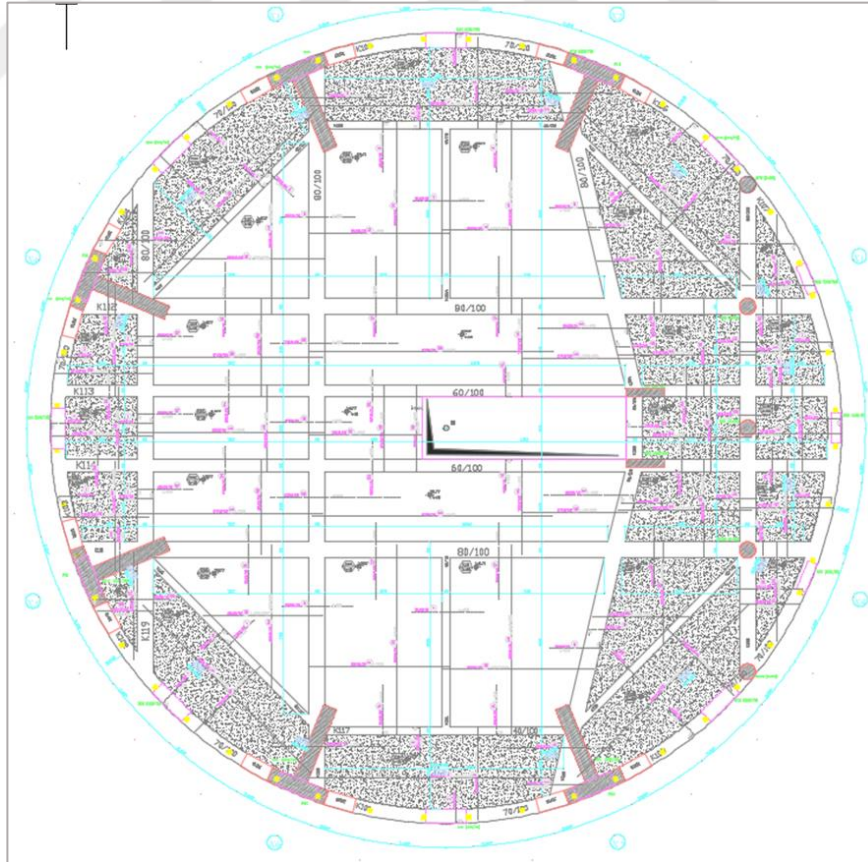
Panorama 1326 statik proje görünüm 4
